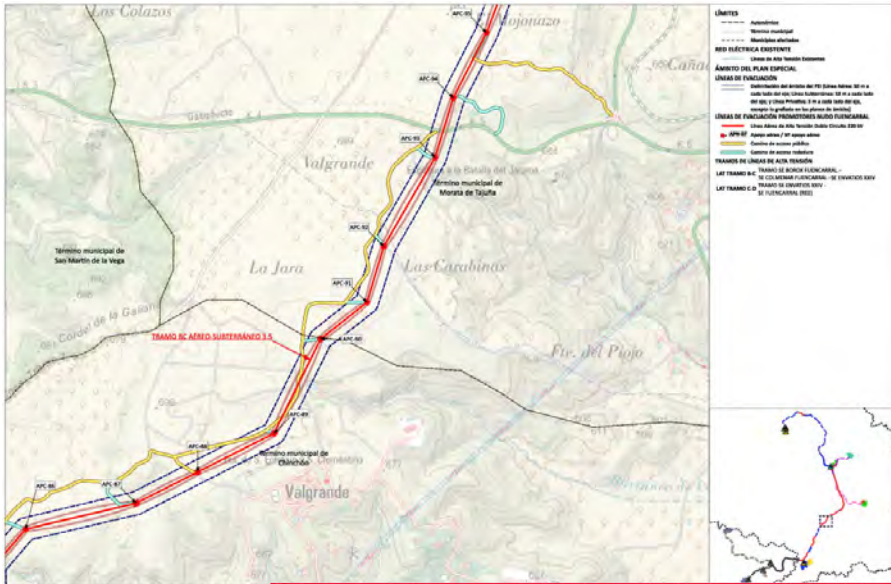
Plano de Ordenación O2.3.7. Planta por tramos. LASAT Promotores Nudo Fuencarral Tramo B-C
